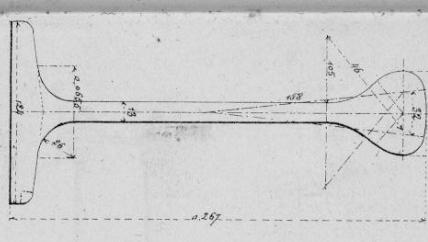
Section du rail et de l'écisse. Const. du Prof.
